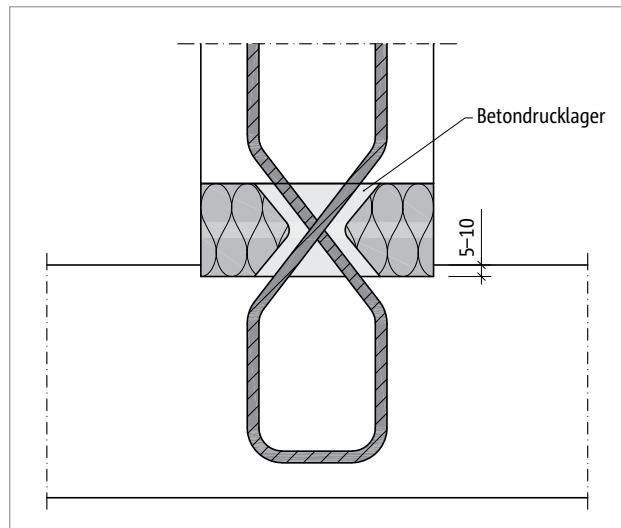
Schöck Sconnex® Typ W: Detail 1; Formschluss durch 5–10 mm tiefe Einsenkung des Dämmkörpers in die Decke
